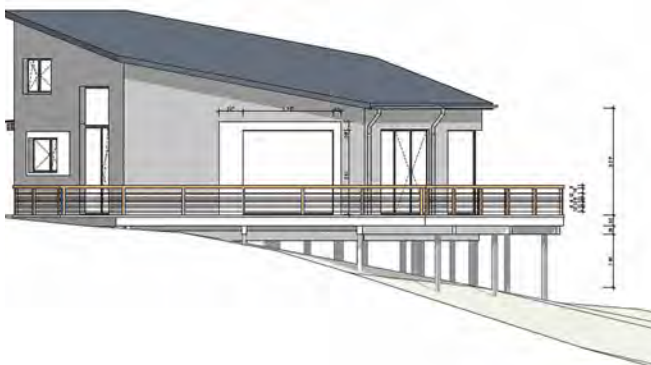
Das Sechseck des Grundrisses ist unregelmäßig und verbindet ideale Grundrissanordnung mit optimaler Grundstücksausnutzung und mit einer sich harmonisch zum Hang neigenden und nach Süden hin abfallenden Dachfläche (Quelle: Architekturbüro Harald Semke)
